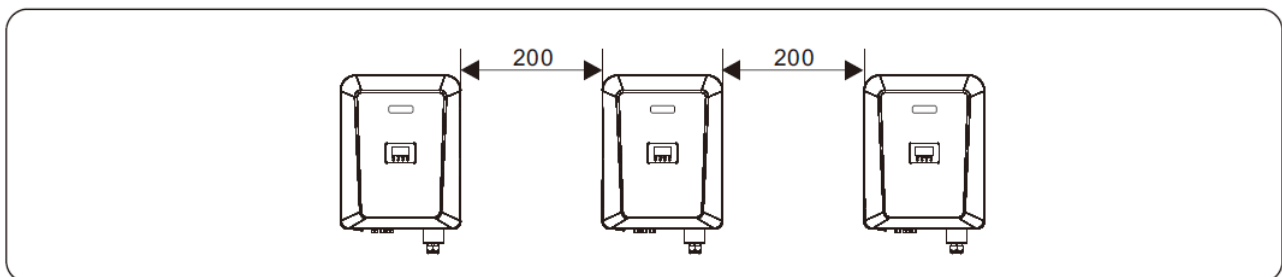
Installazione lungo la stessa linea (unità: mm)
